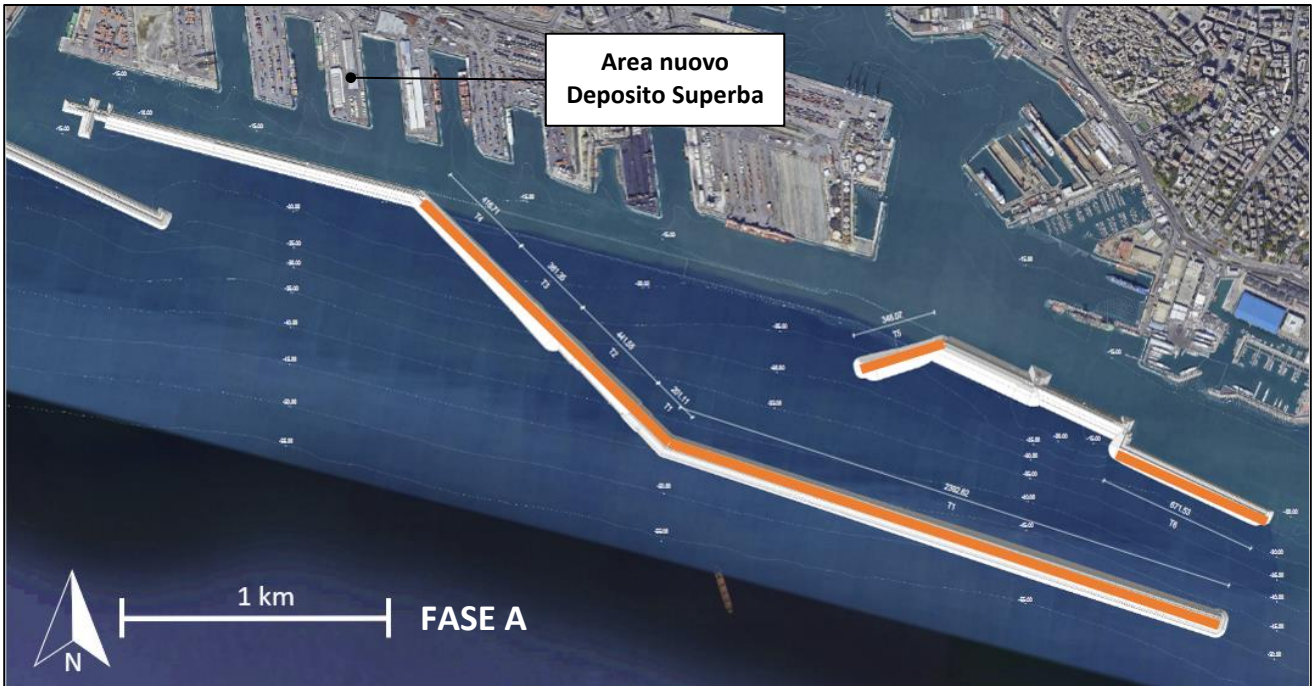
Estratto Planimetria generale dell'intervento di realizzazione della nuova diga foranea del porto di Genova.
